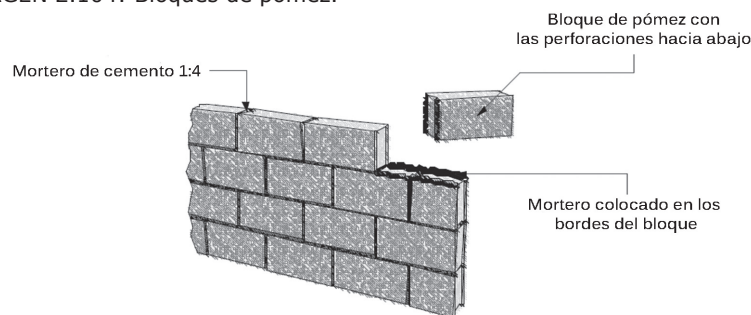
Detalle de la colocación del mortero y bloques.
